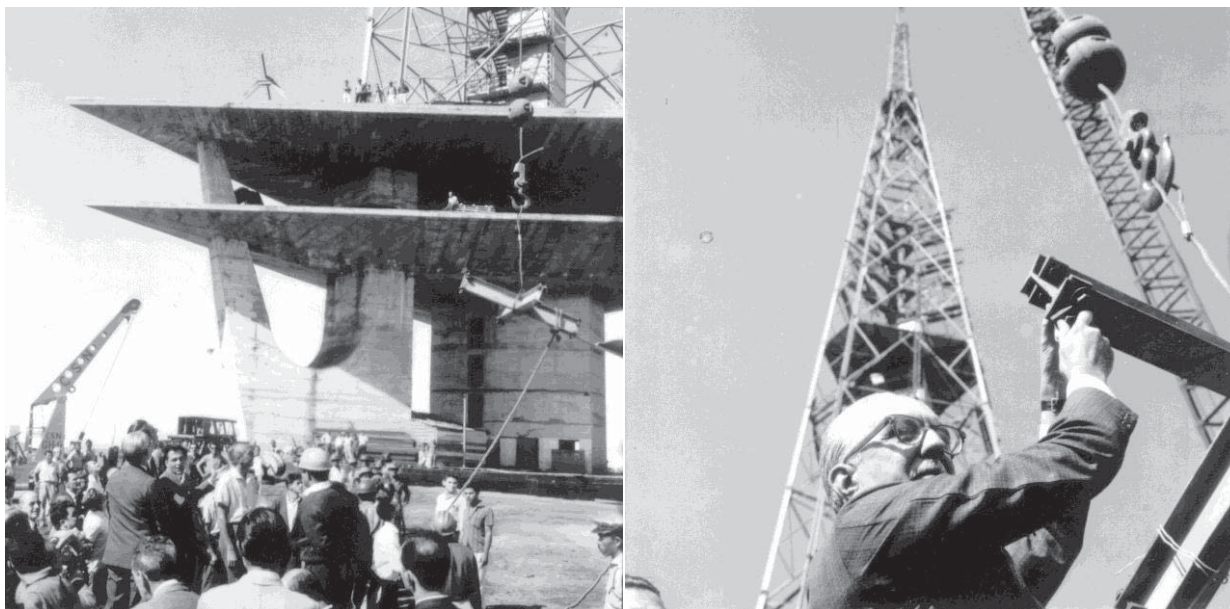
Montagem final da estrutura metálica da Torre (Fonte: ArPDF, Nº:1557 e 1556, Conteúdo: Construção da Torre de TV).
